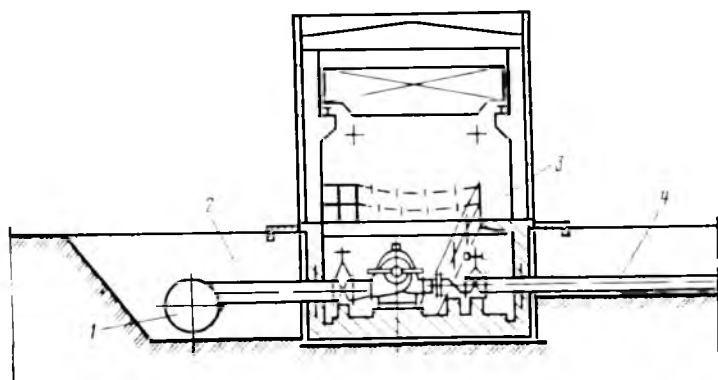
Конструктивная схема насосной станции с забором воды из ВБ плотинного гидроузла:
